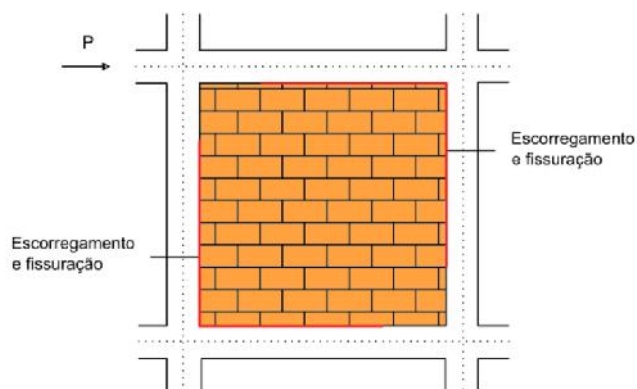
Fenómenos de escorregamento e aparecimento de fendas em todo o perímetro da parede de enchimento devido ao aumento das forças.
